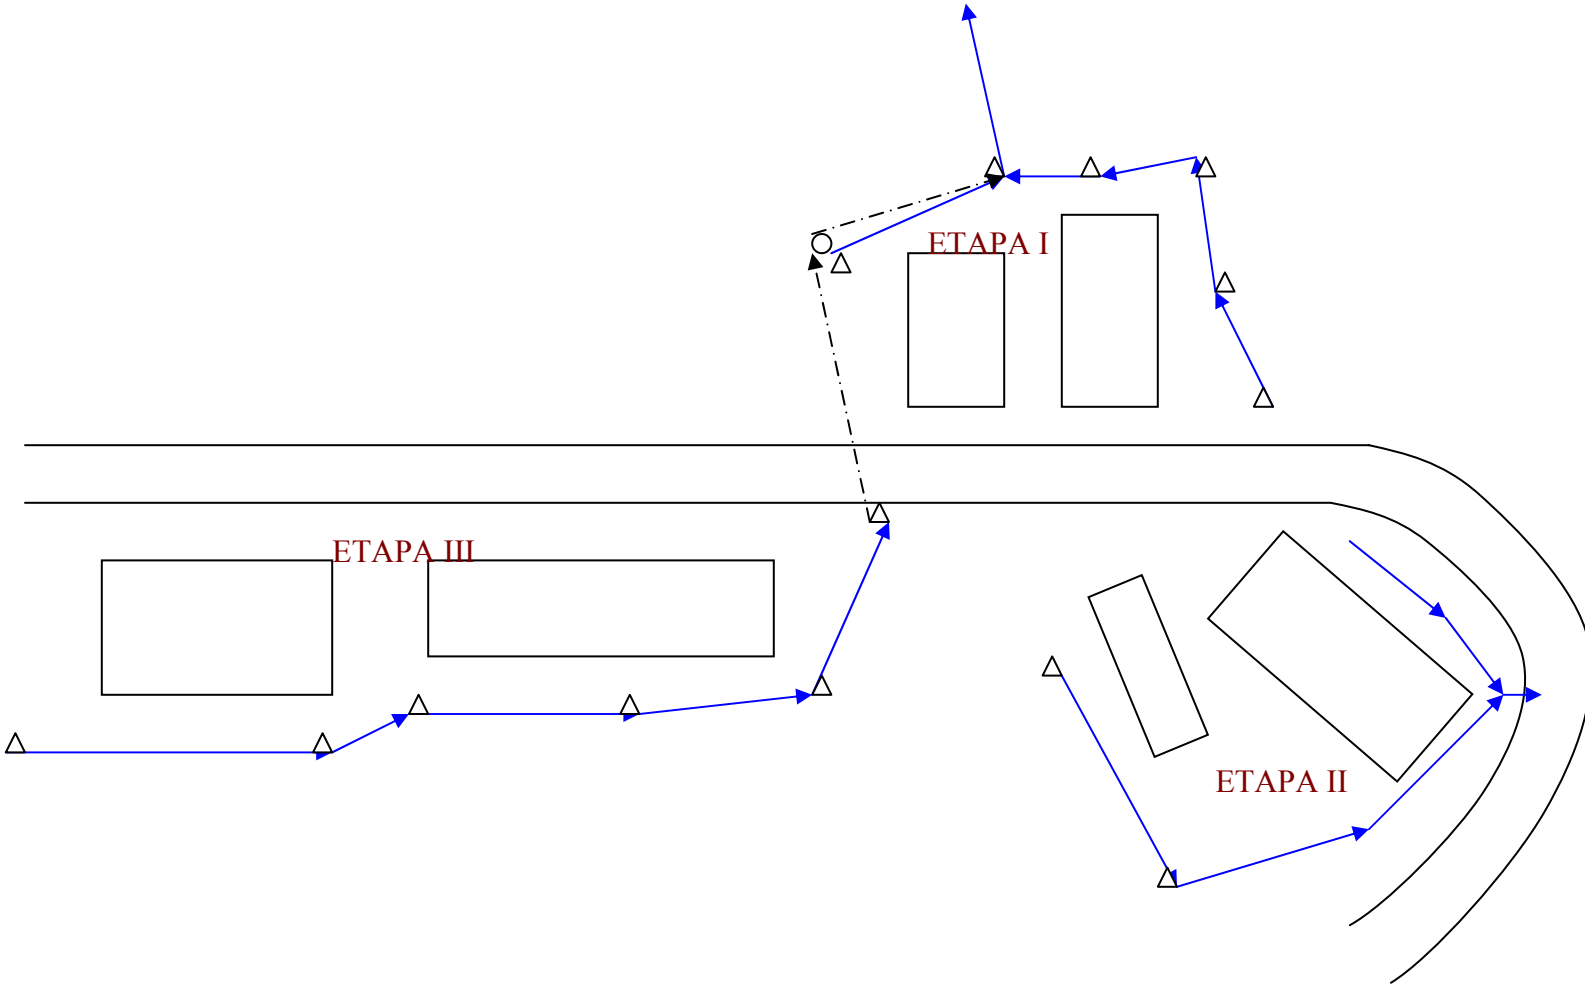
Línea en la que se ubicarán las canaletas perimetrales.
